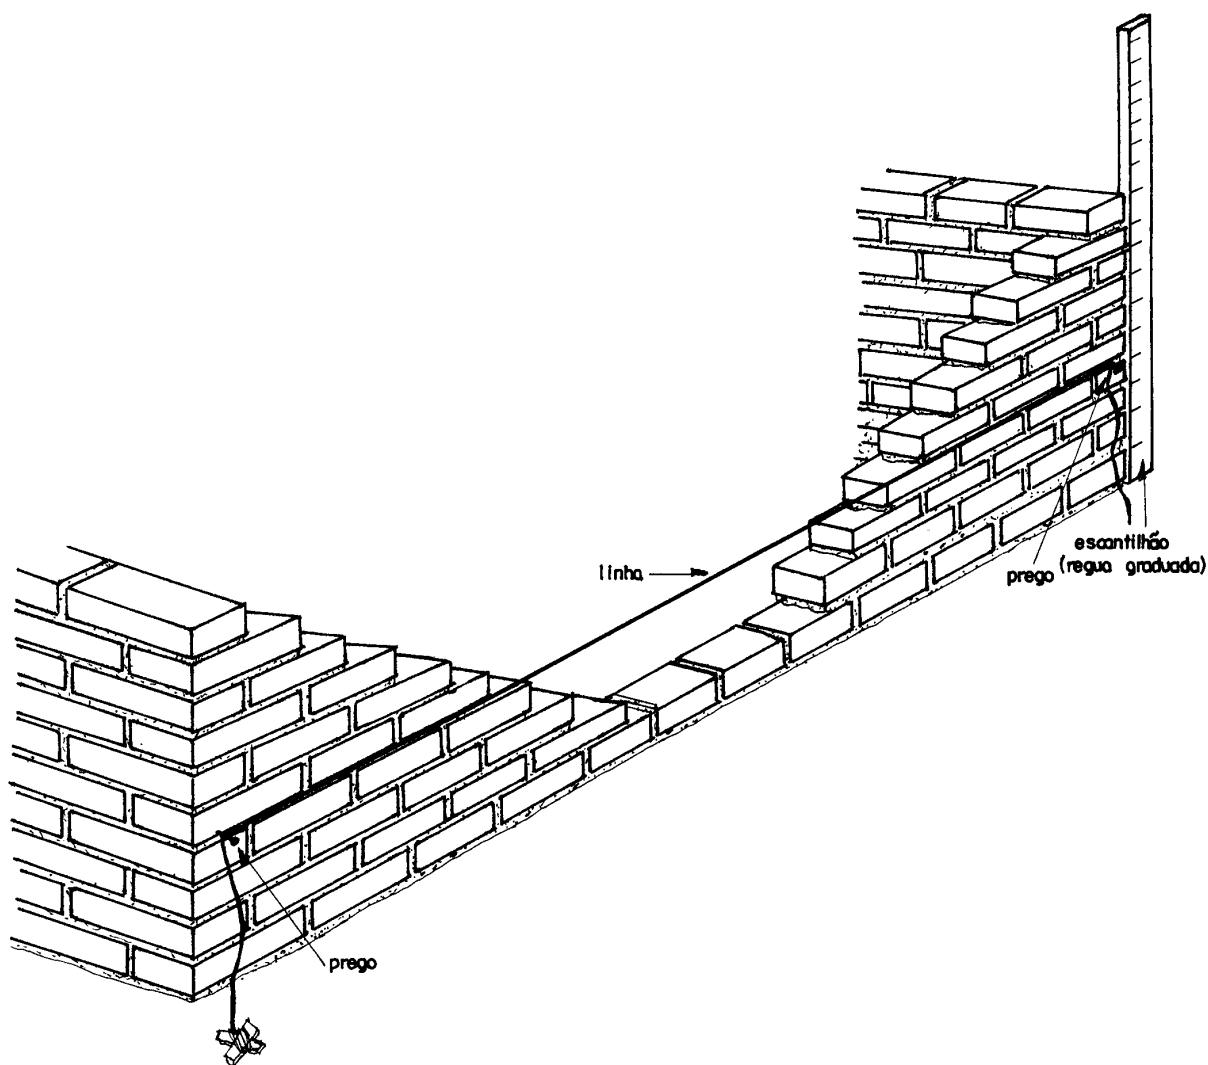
Detalhe do nivelamento da elevação da alvenaria
